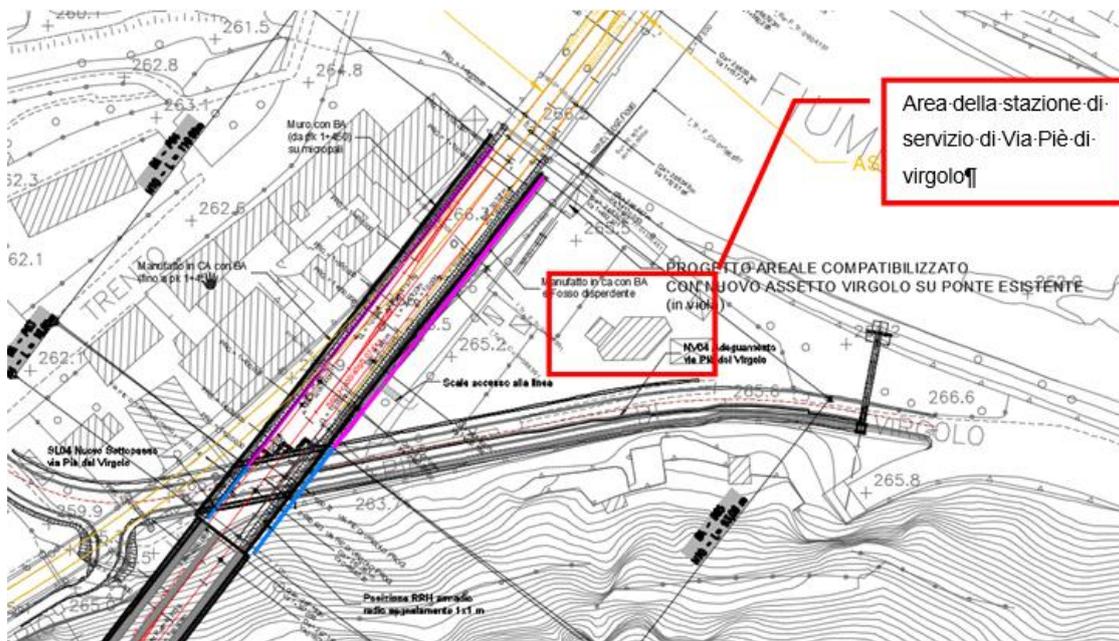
Planimetria delle opere con dettaglio dell'area della stazione di servizio
